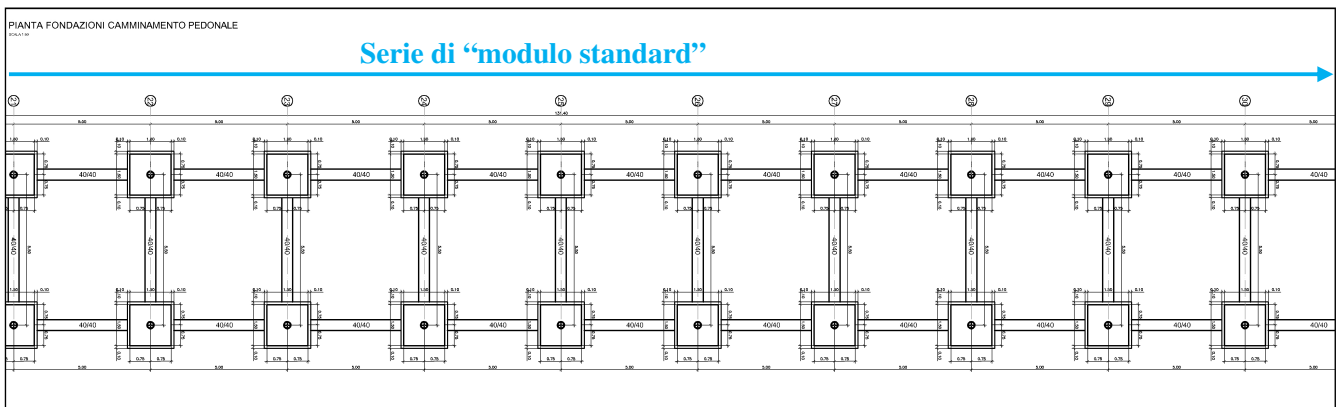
Estratto pianta delle fondazioni del Camminamento pedonale
